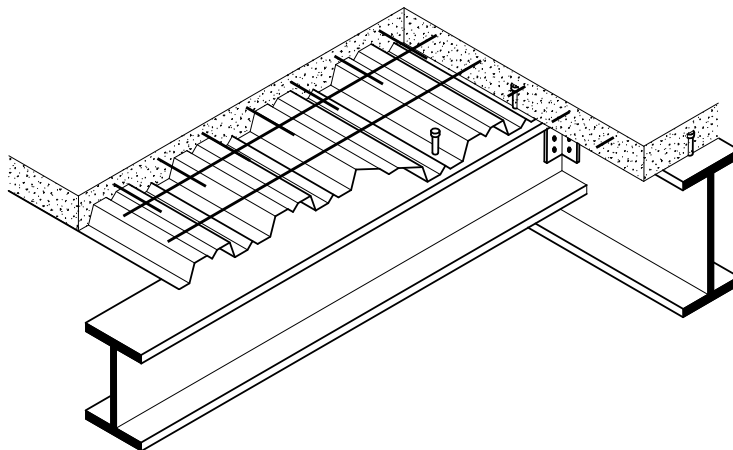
Vue écorchée d'une construction de plancher mixte typique
